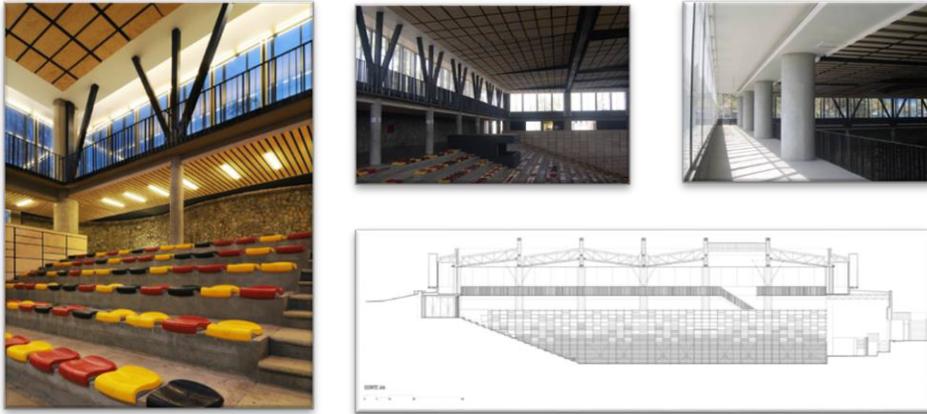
, 44 y 45; Estructura, "Centro de Encuentro Chimkowe."
